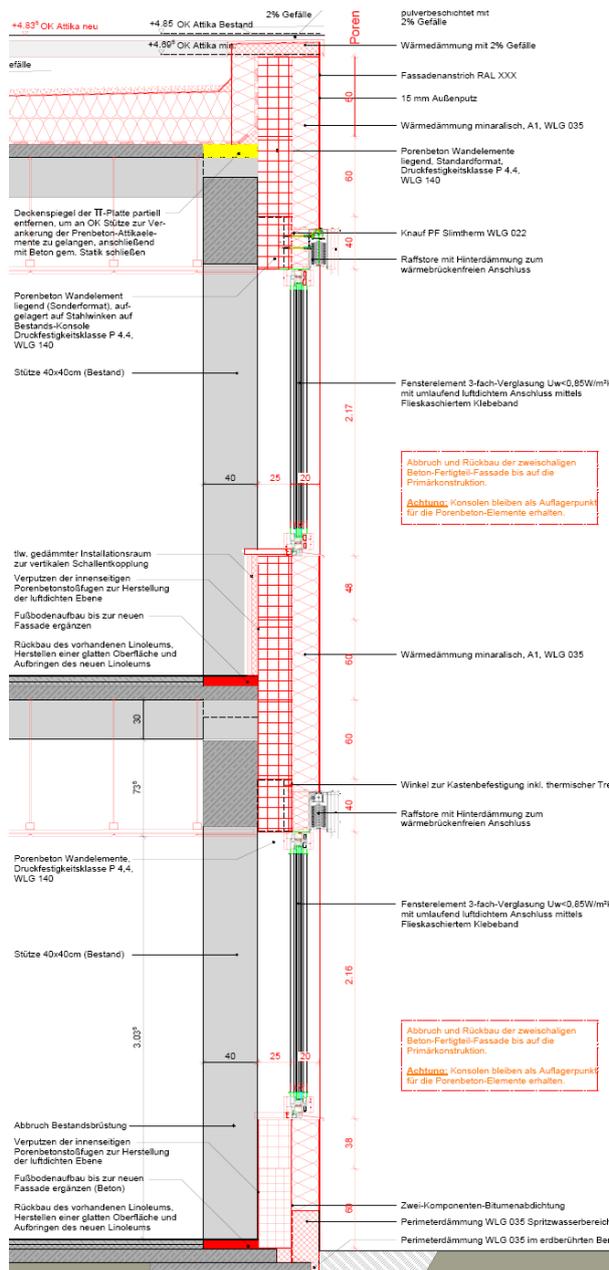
Fassadenschnitt durch Fensterbänder gemäß Vorplanung (Typ 1) [U2]
